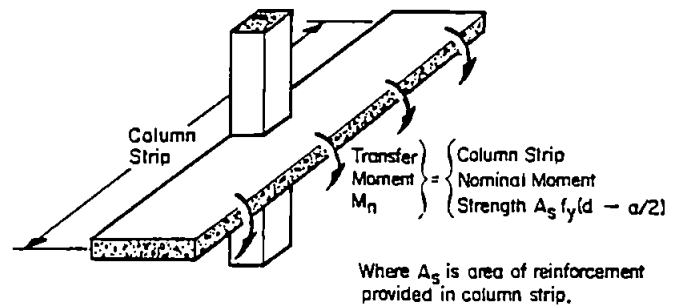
Transmisión de momento entre la losa y la columna según la sección 13.6.3.6.
